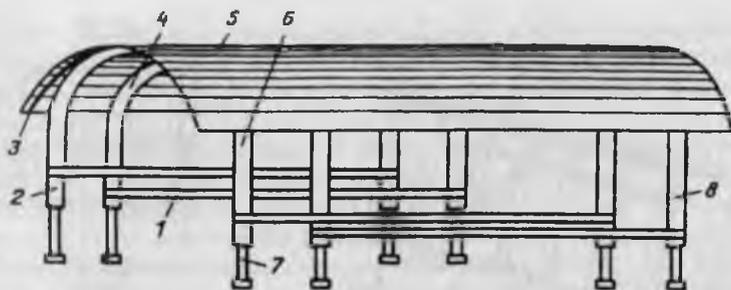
Механизированная передвижная крепь КМК-3 конструкции ЦНИИ-подземмаша:
